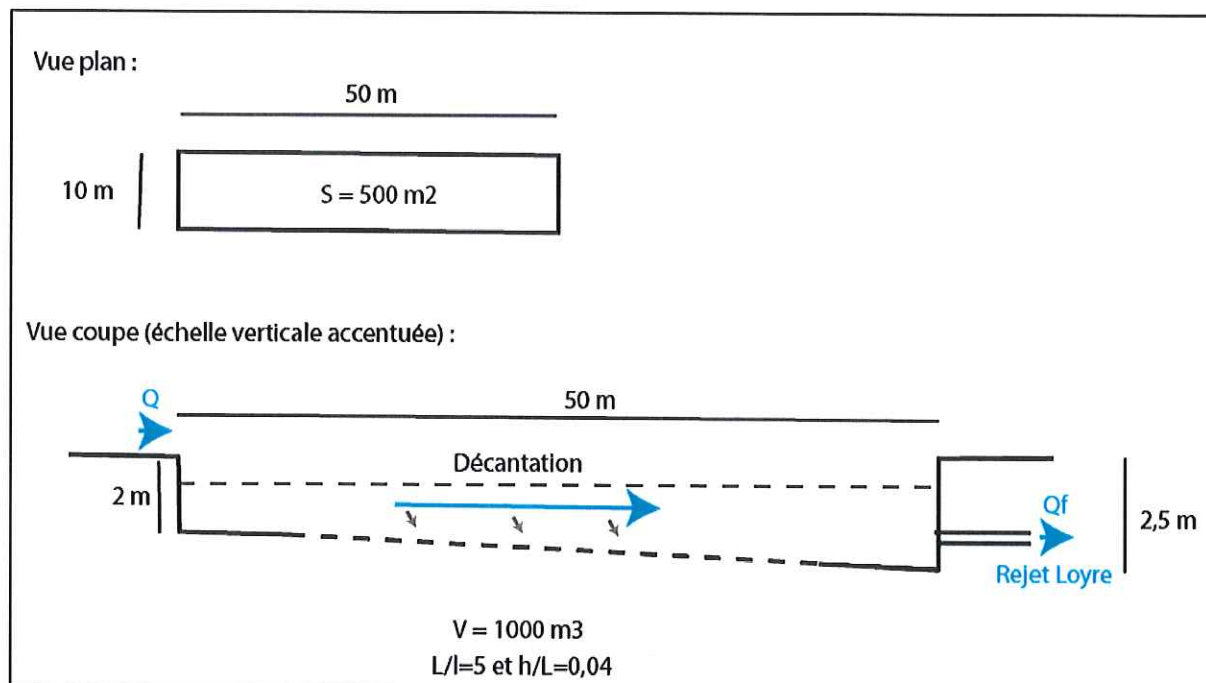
Dimensions du bassin de décantation à l'entrée de la carrière
